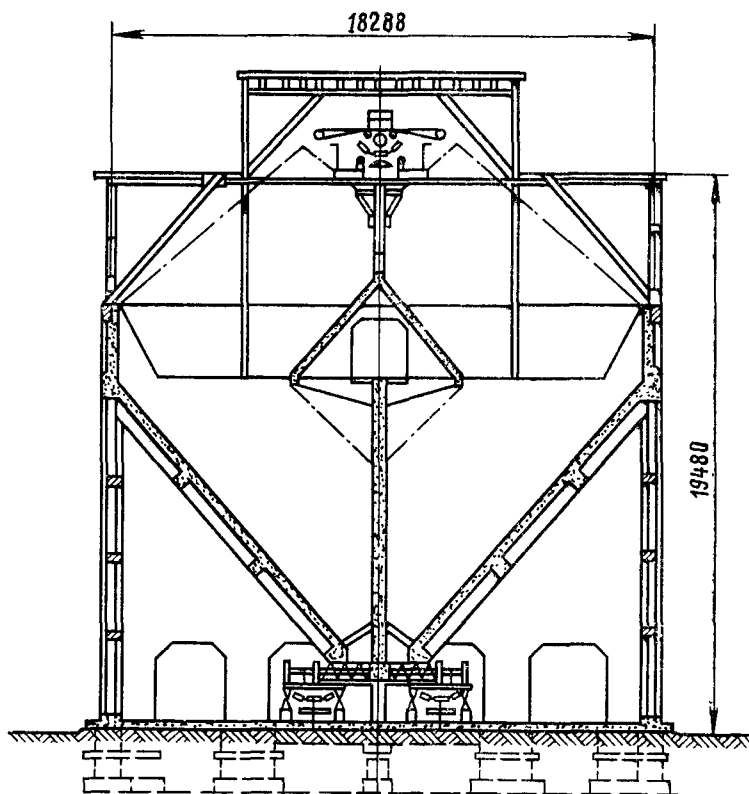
Поперечный разрез наземного бункера для щепы с разделительной стенкой
